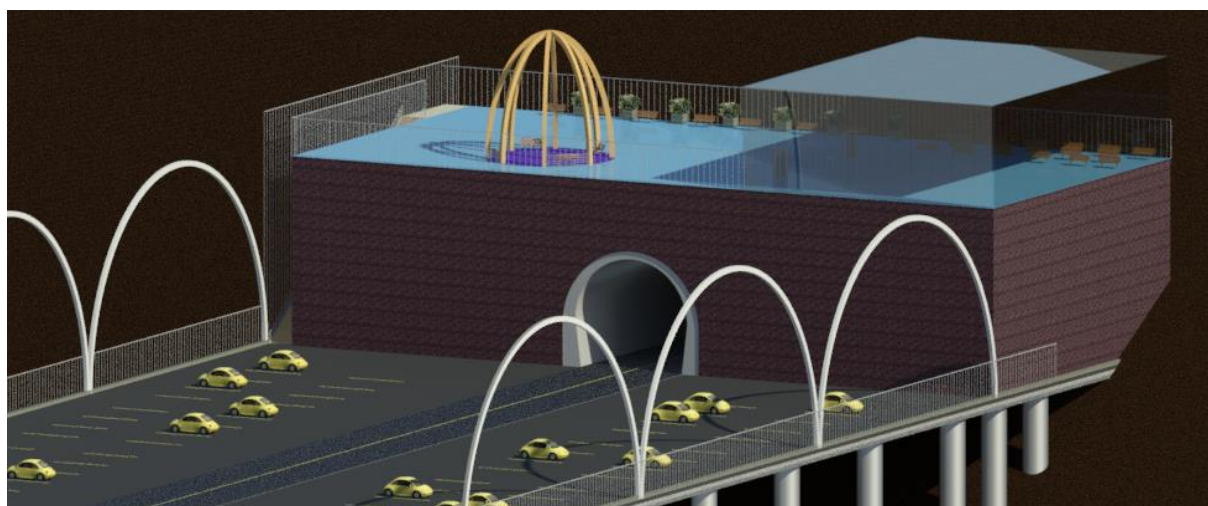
Главный вид портала в осях 15-1 и 24-23
